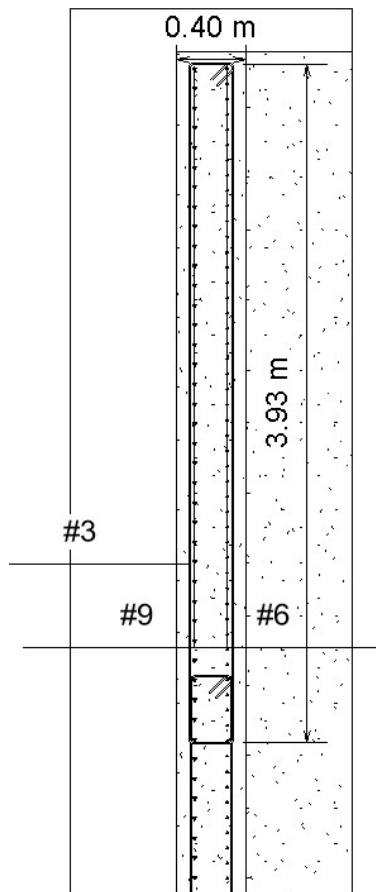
Detalle del refuerzo longitudinal de muro exterior de alcantarilla de una celda.
